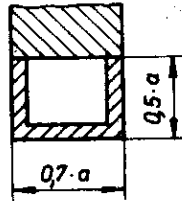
Grundriß ohne Fuge mit starrem Anschluß
